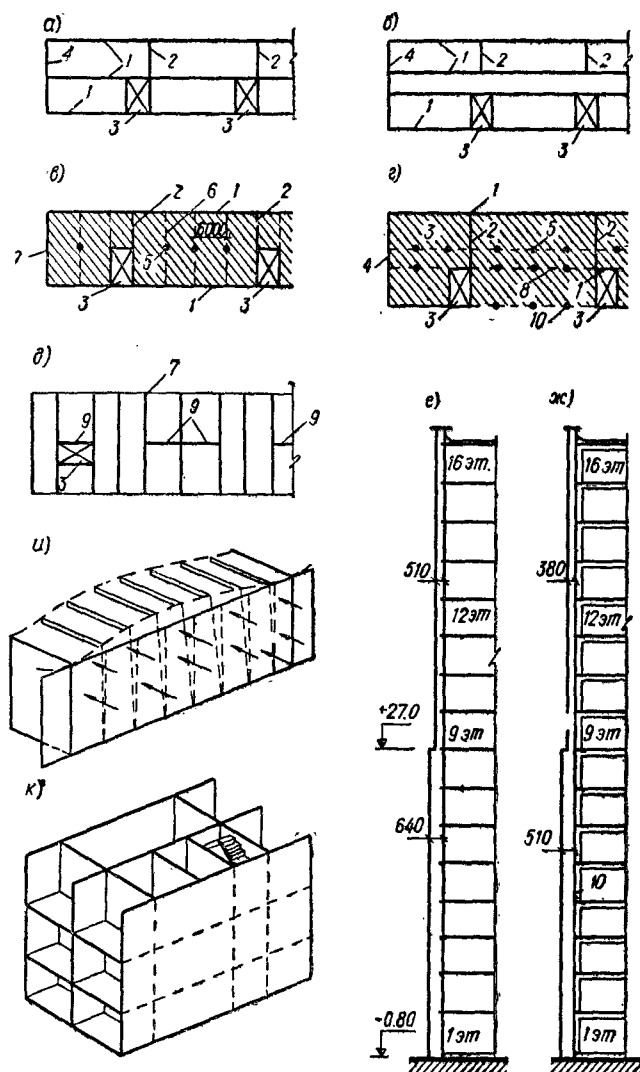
Несущие остова многоэтажных каменных зданий
